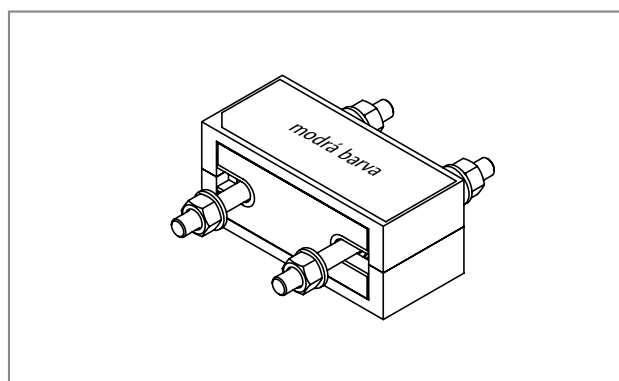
Schöck Isokorb® T typ S-V-D22: Řez prvkem
